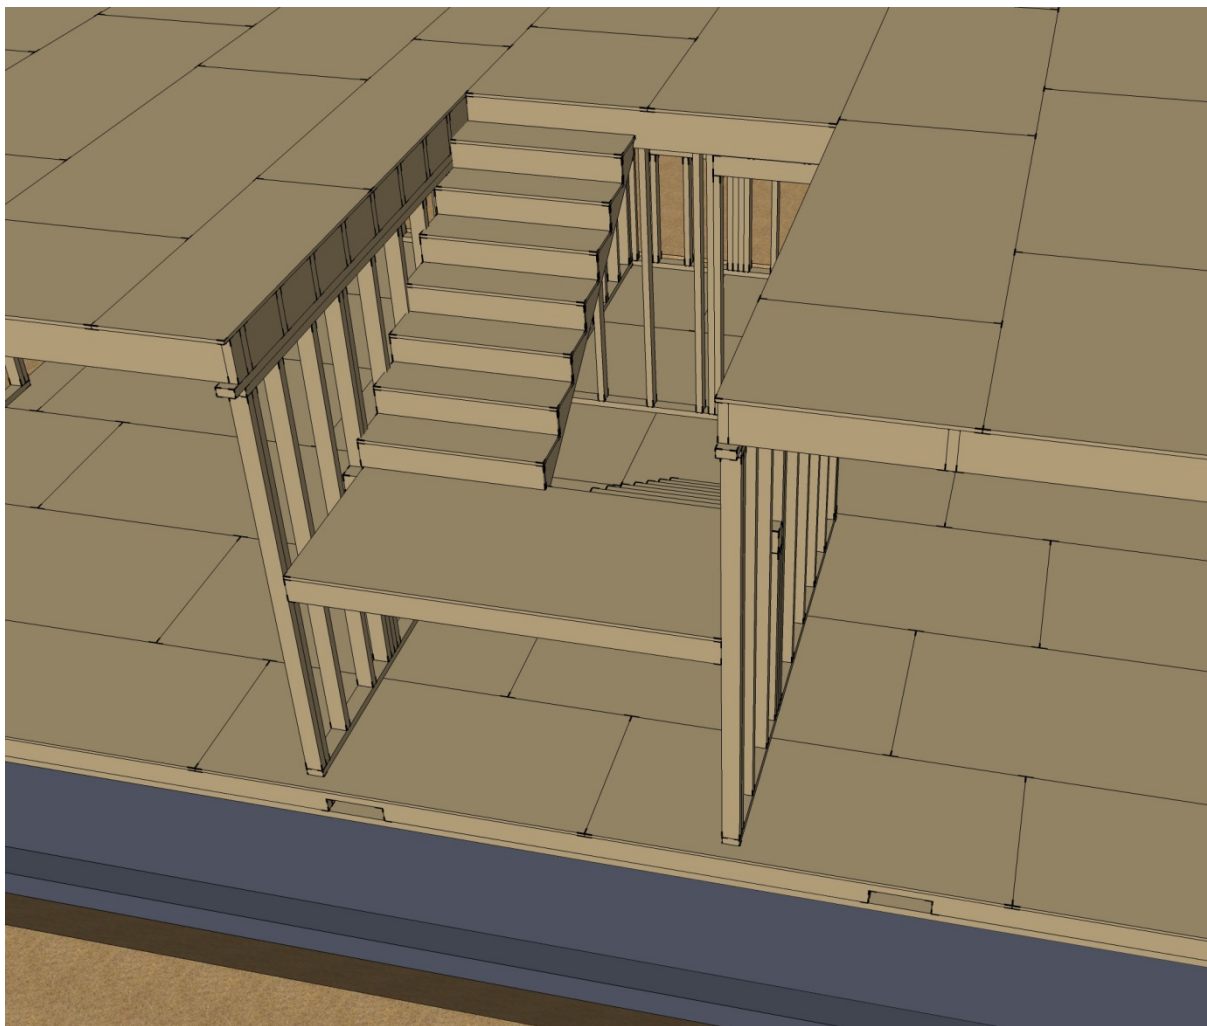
Montagem de forro estrutural nas escadas e patamar.
